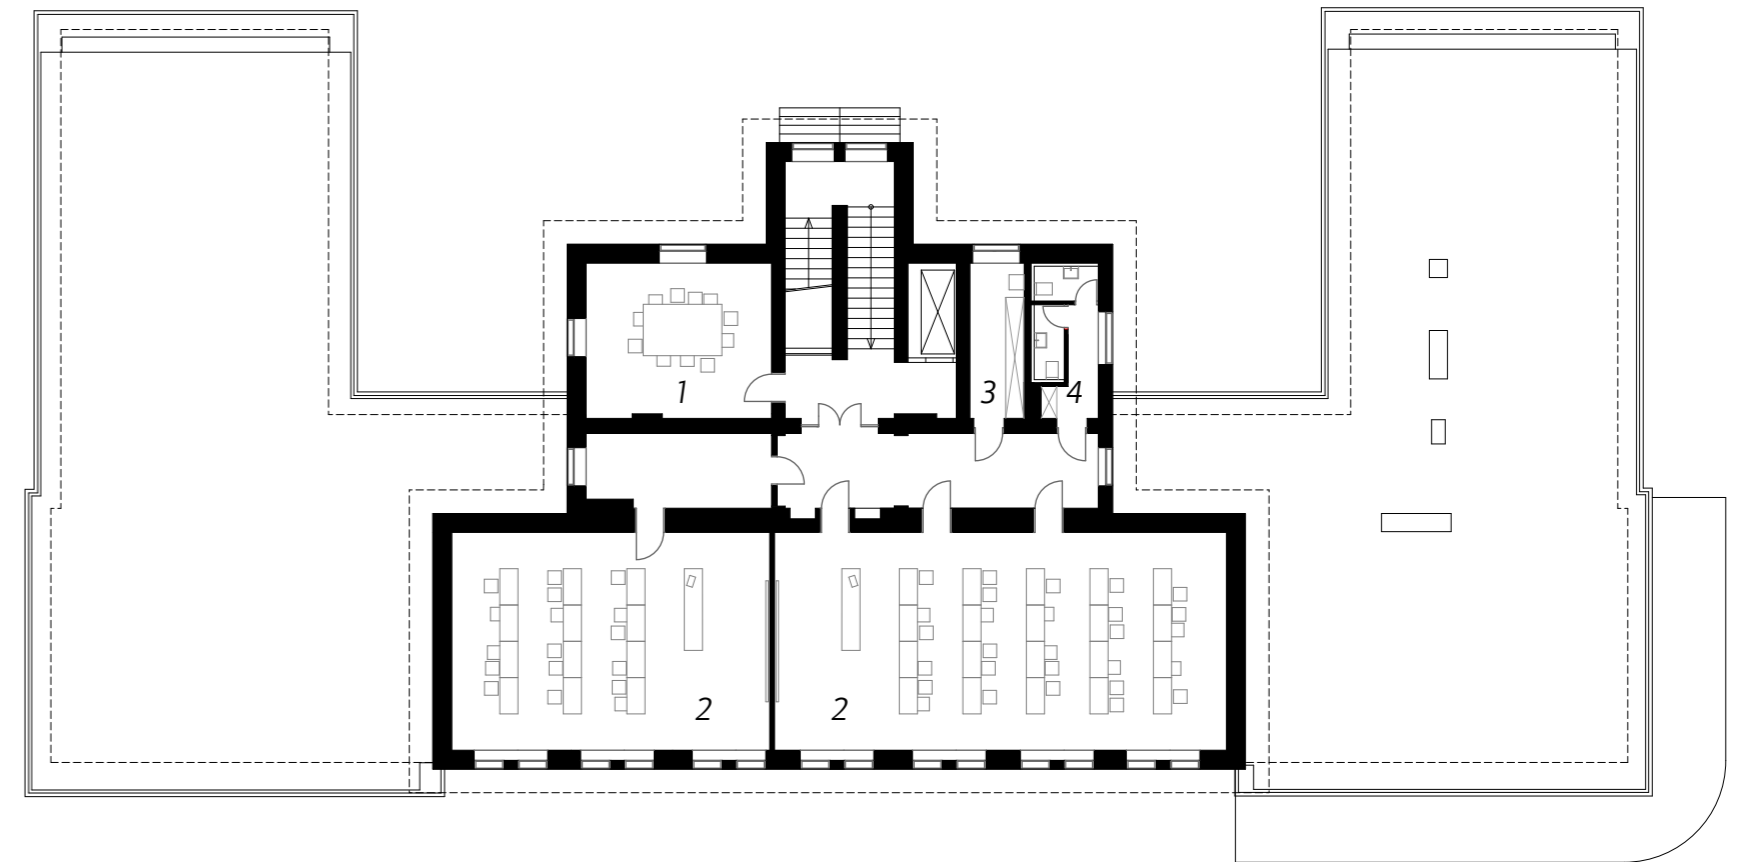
Umbaumaßnahmen Pavillon 12 | 2.Obergeschoss | M 1-250
